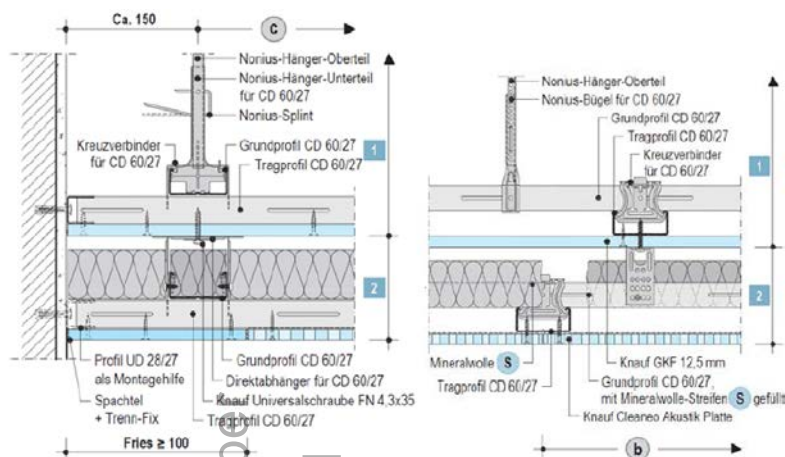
D124.de Wandanschluss und Deckenaufbau Trag- und Grundprofil in der zweiten Deckenebene
